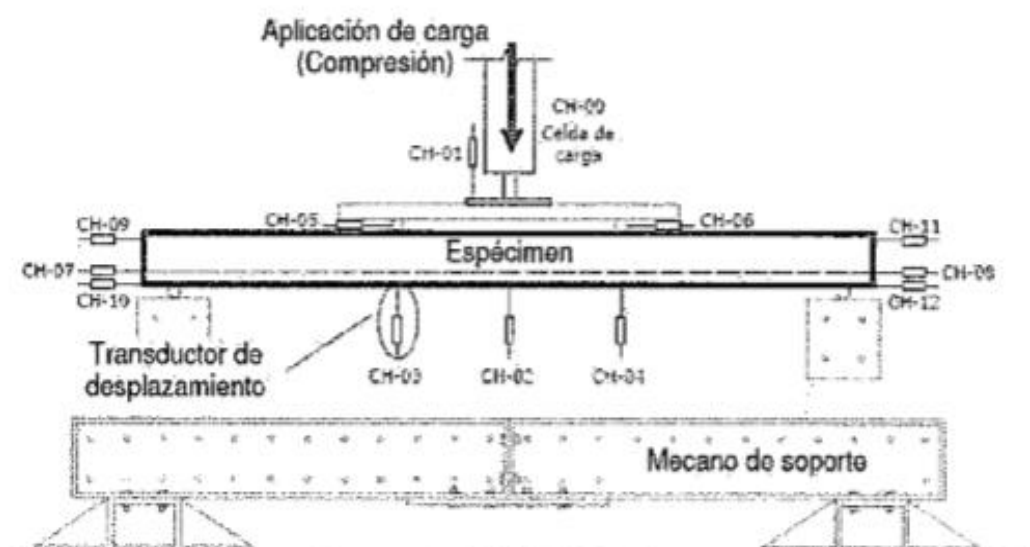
Detalle del ensayo a flexión de losa aligerada (Fuente: CISMID - UNI)
